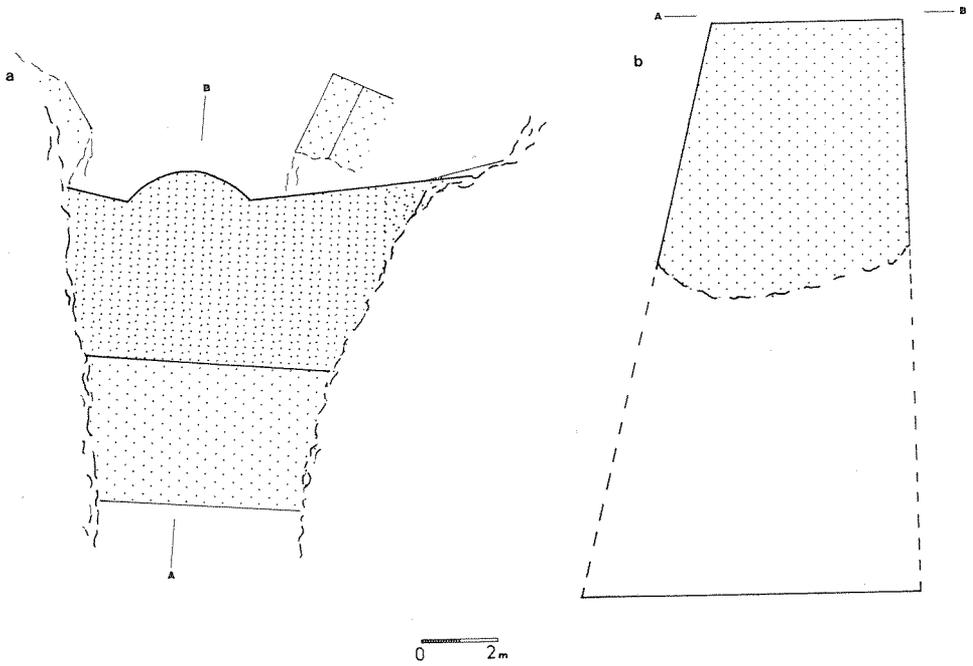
Pantano de la Reina (Dalías). Presa de argamasa sobre la rambla de Almacete (a: planta; b: sección).
